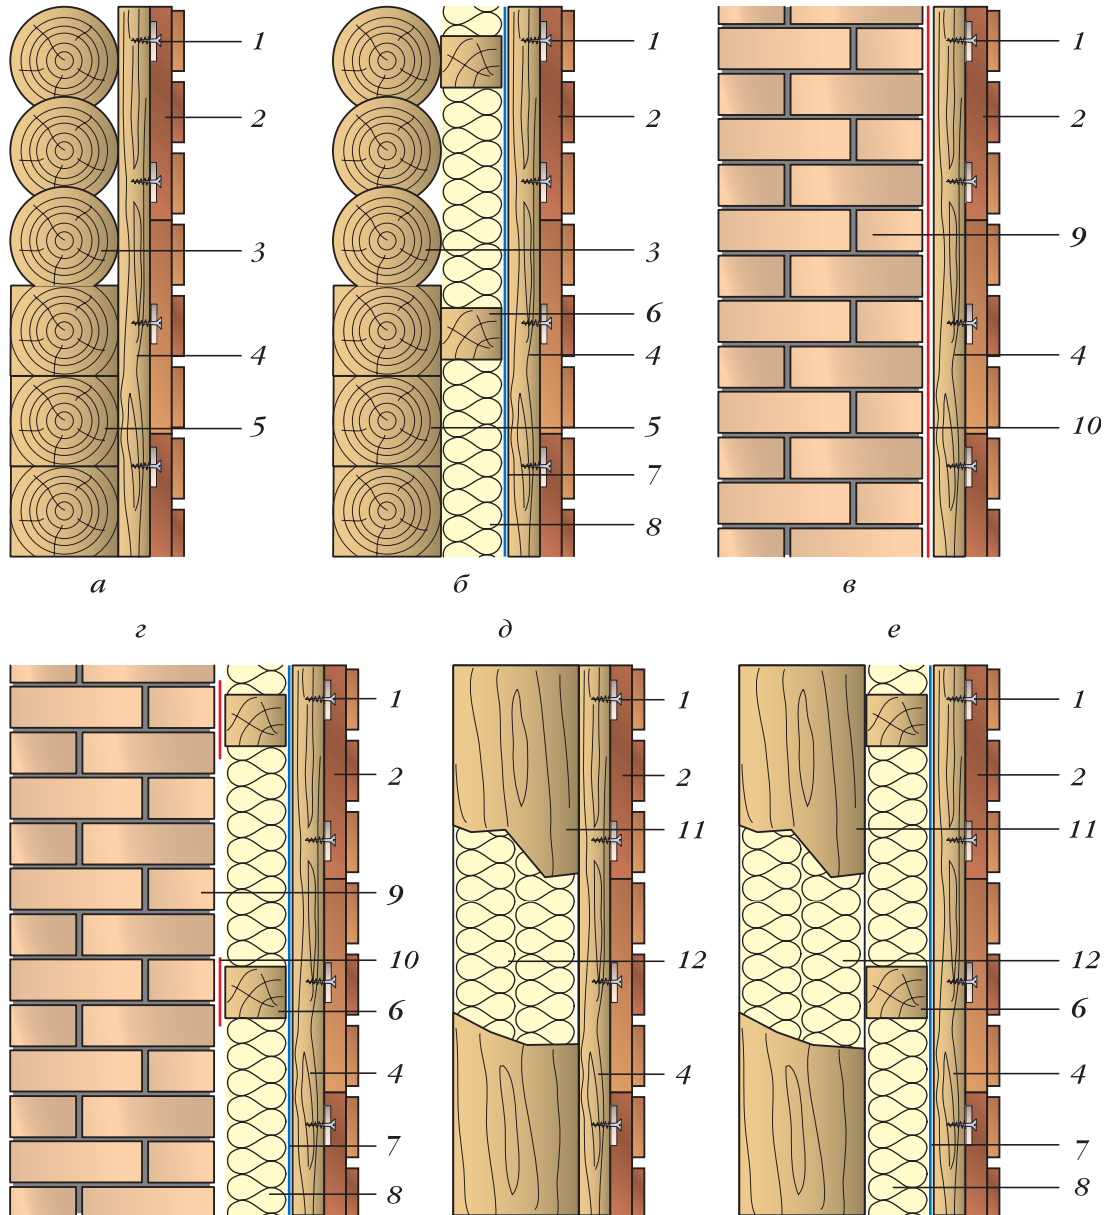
Облицовка стен из различных материалов: а — деревянных рубленых и брусовых без утепления; б — то же, с утеплением; в — кирпичных, бетонных и т. п. без утепления; г — то же, с утеплением; д — каркасных без утепления; е — то же, с утеплением; 1 — крепление панели саморезами; 2 — облицовочная плита; 3 — рубленая стена; 4 — вертикальная обрешетка; 5 — брусовая стена; 6 — горизонтальная обрешетка; 7 — ветроизоляция; 8 — утеплитель; 9 — кирпичная стена; 10 — гидроизоляция; 11 — стойка каркасной стены; 12 — утеплитель каркасной стены
